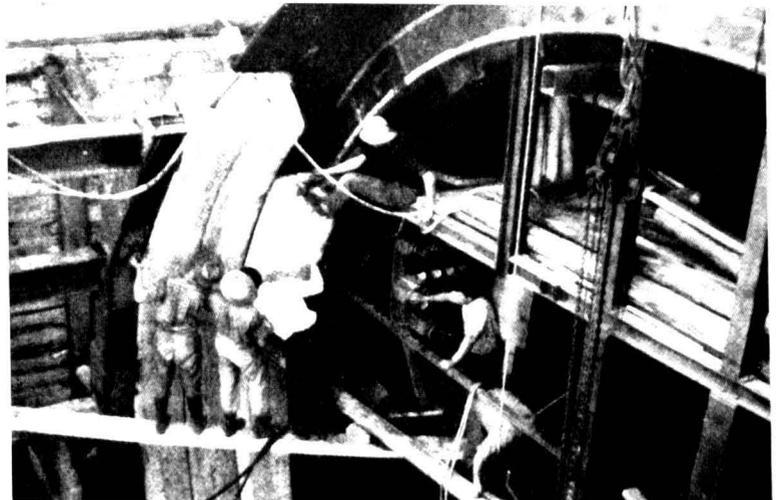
Kreuzliberg-Tunnelbau mit Stahlbögen
